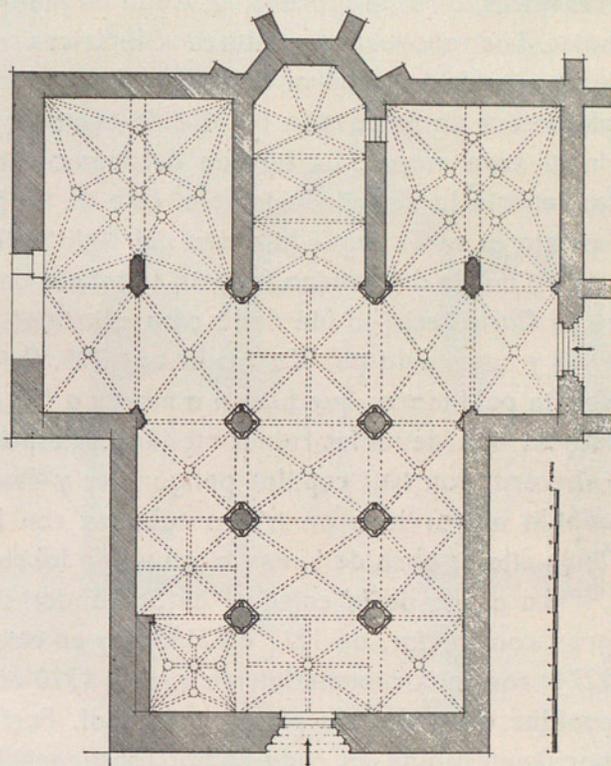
PLANTA DE LA IGLESIA DE SAN GIL, DE BURGOS.
